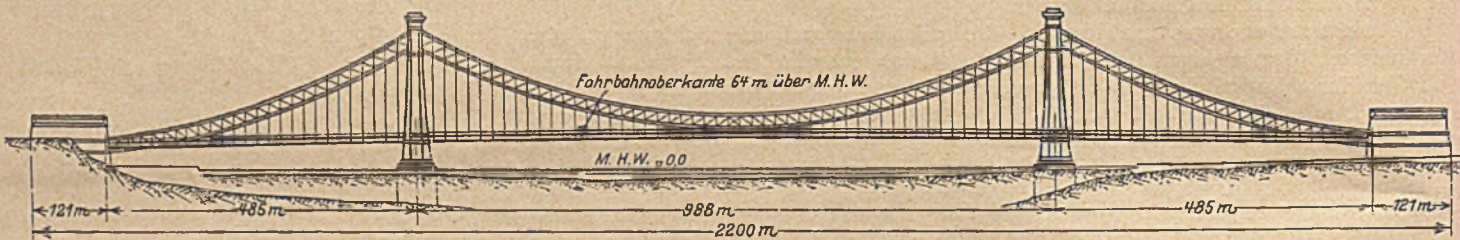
Brücke über den North River im Zuge der 57. Straße (New York Stadt), Lindenthalscher Entwurf.
